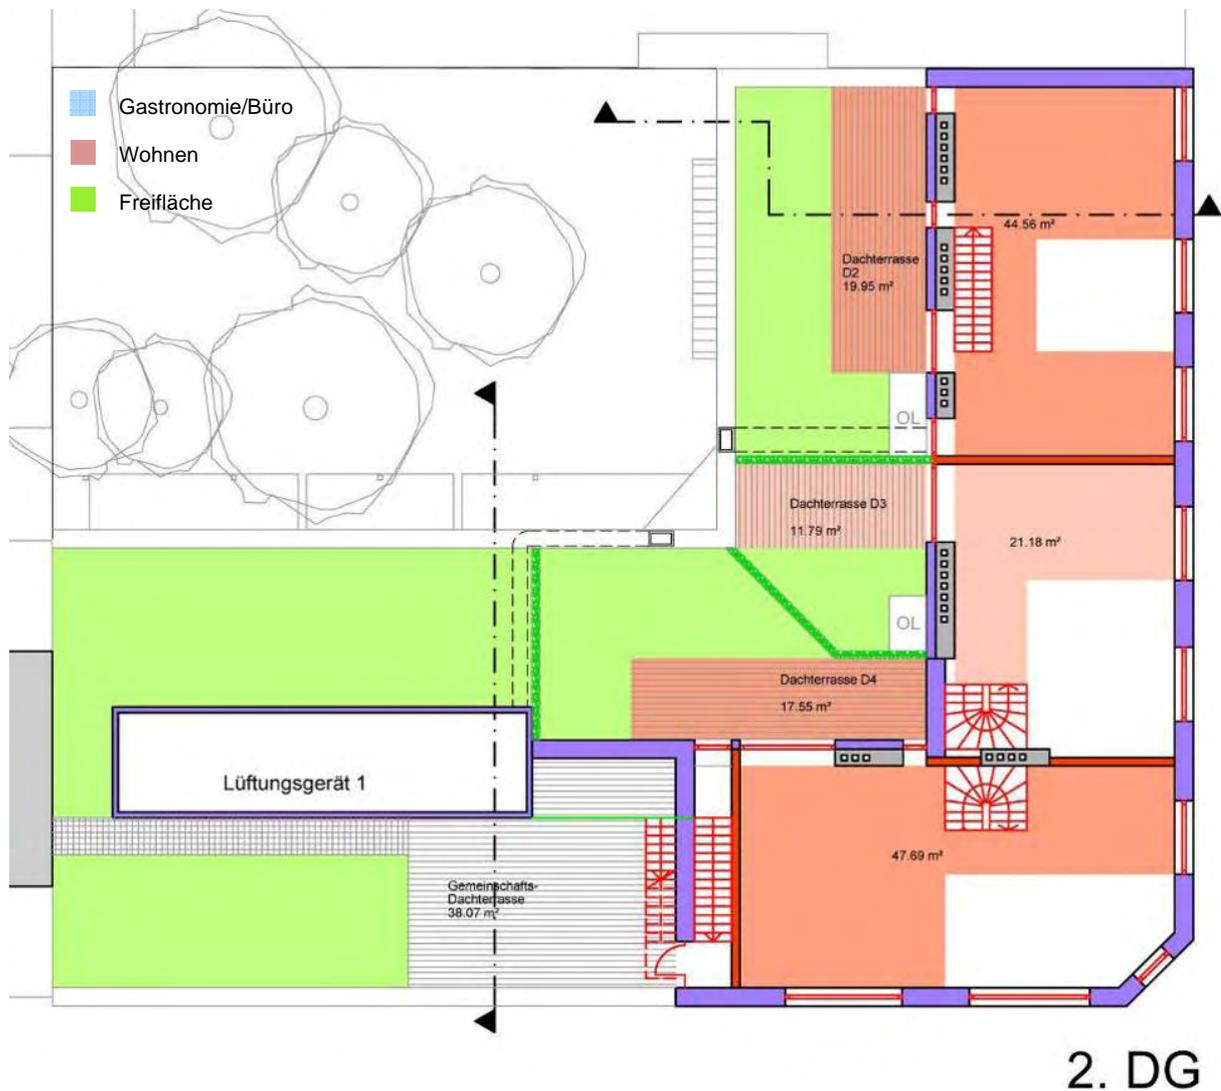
Grundriss 2. Dachgeschoß
